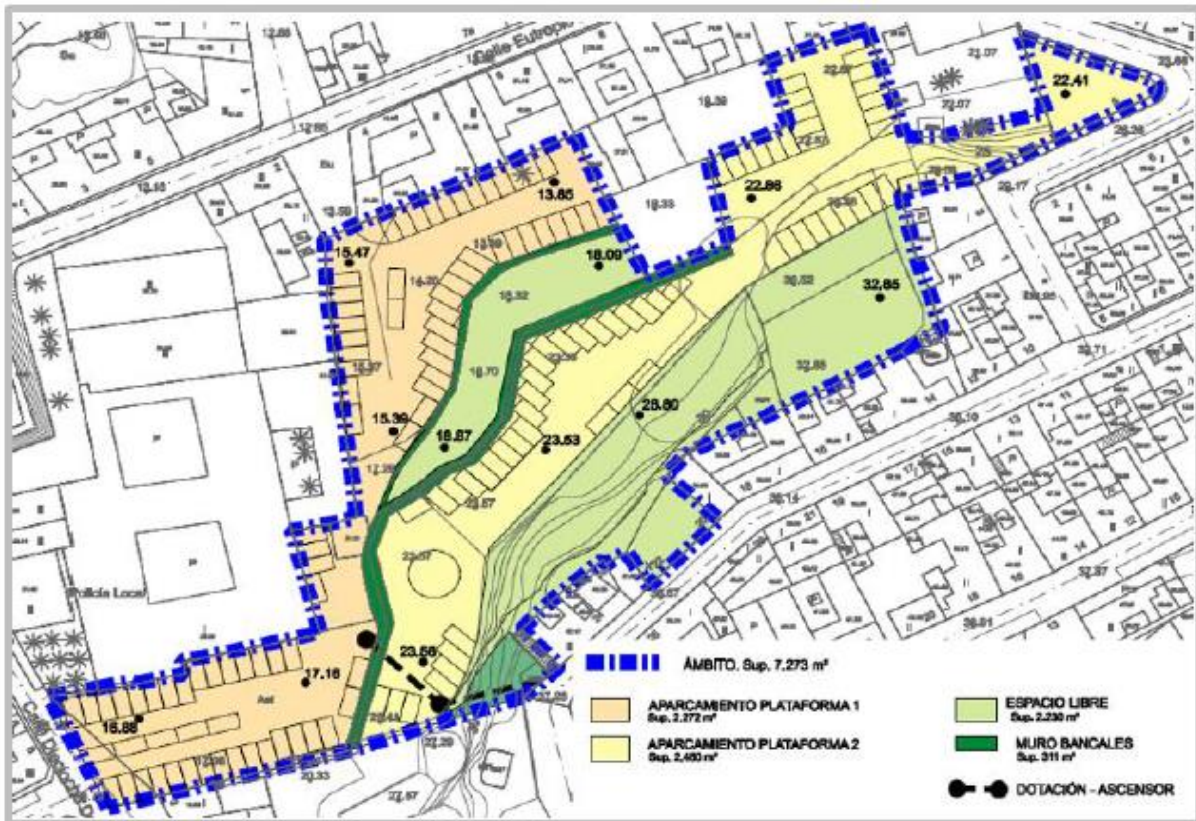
UA.1 Traseira de Ayuntamiento. Plano de ordenación de la modificación menor en tramitación. Fuente: Documento de Borrador de la modificación menor.
